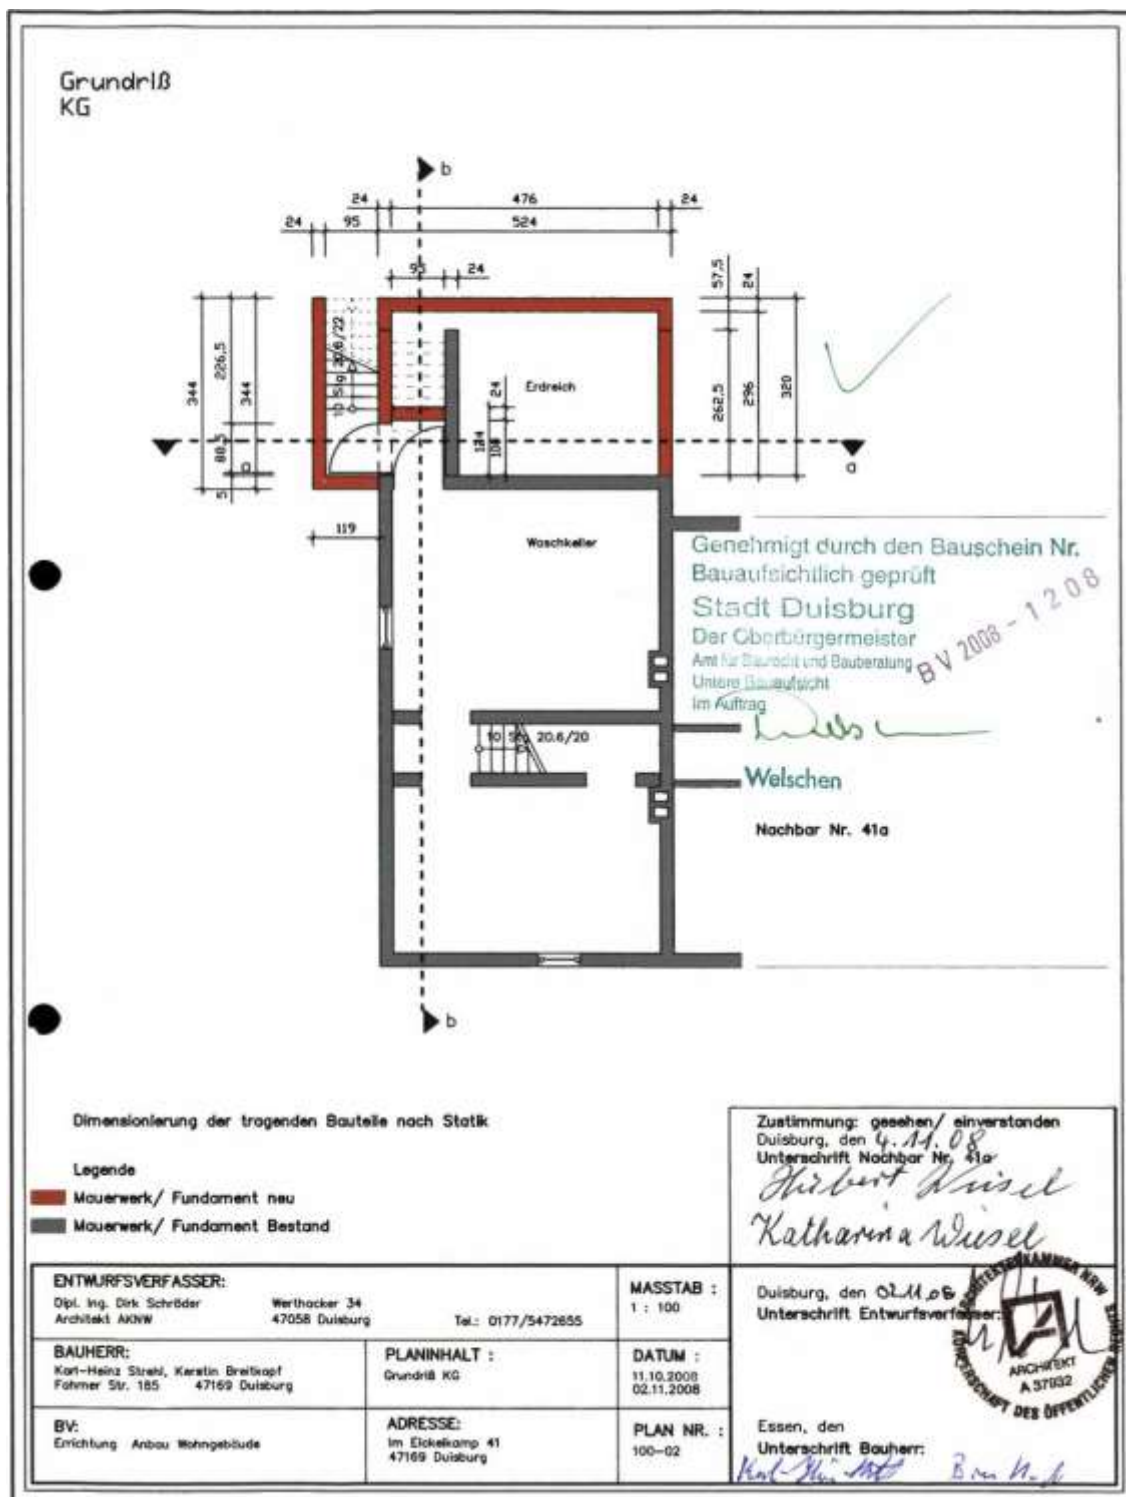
Grundriß Kellergeschoss Quelle: Hausakte der Stadt Duisburg
